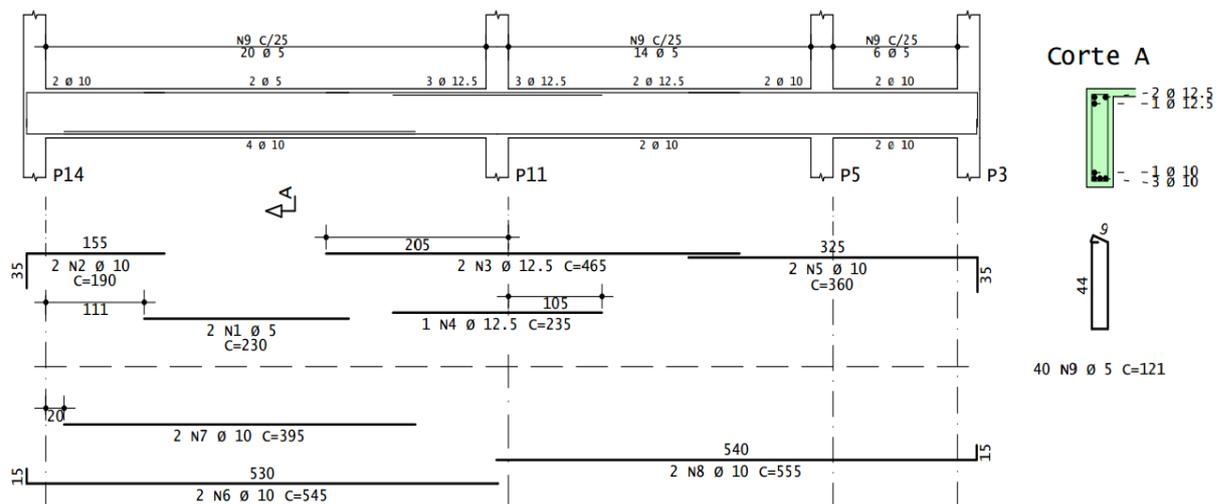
Armadura da viga V10 – pavimento superior (nível +3,00)
